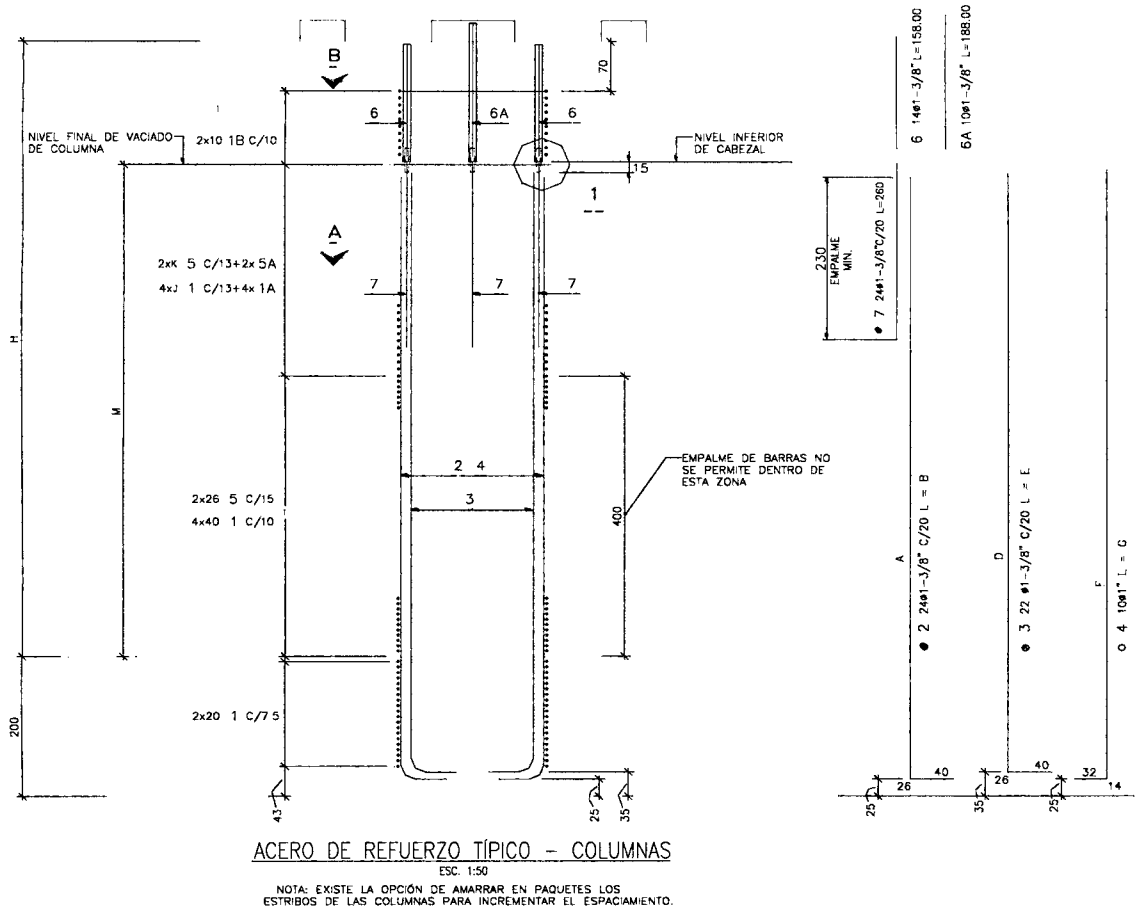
Detalle de acero de columna y el empalme con la viga cabezal.
